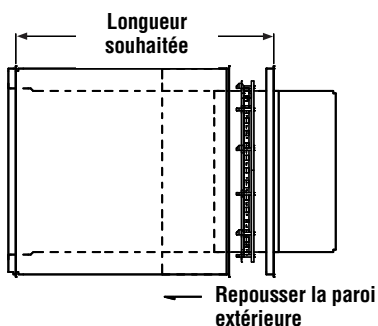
Longueur ajustable, ÉTAPE D'INSTALLATION B
